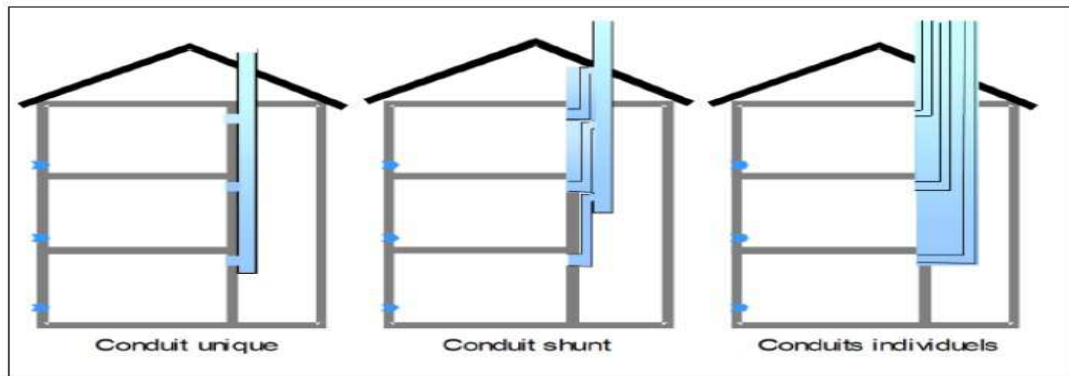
Illustrations de la ventilation naturelle par conduits verticaux.
